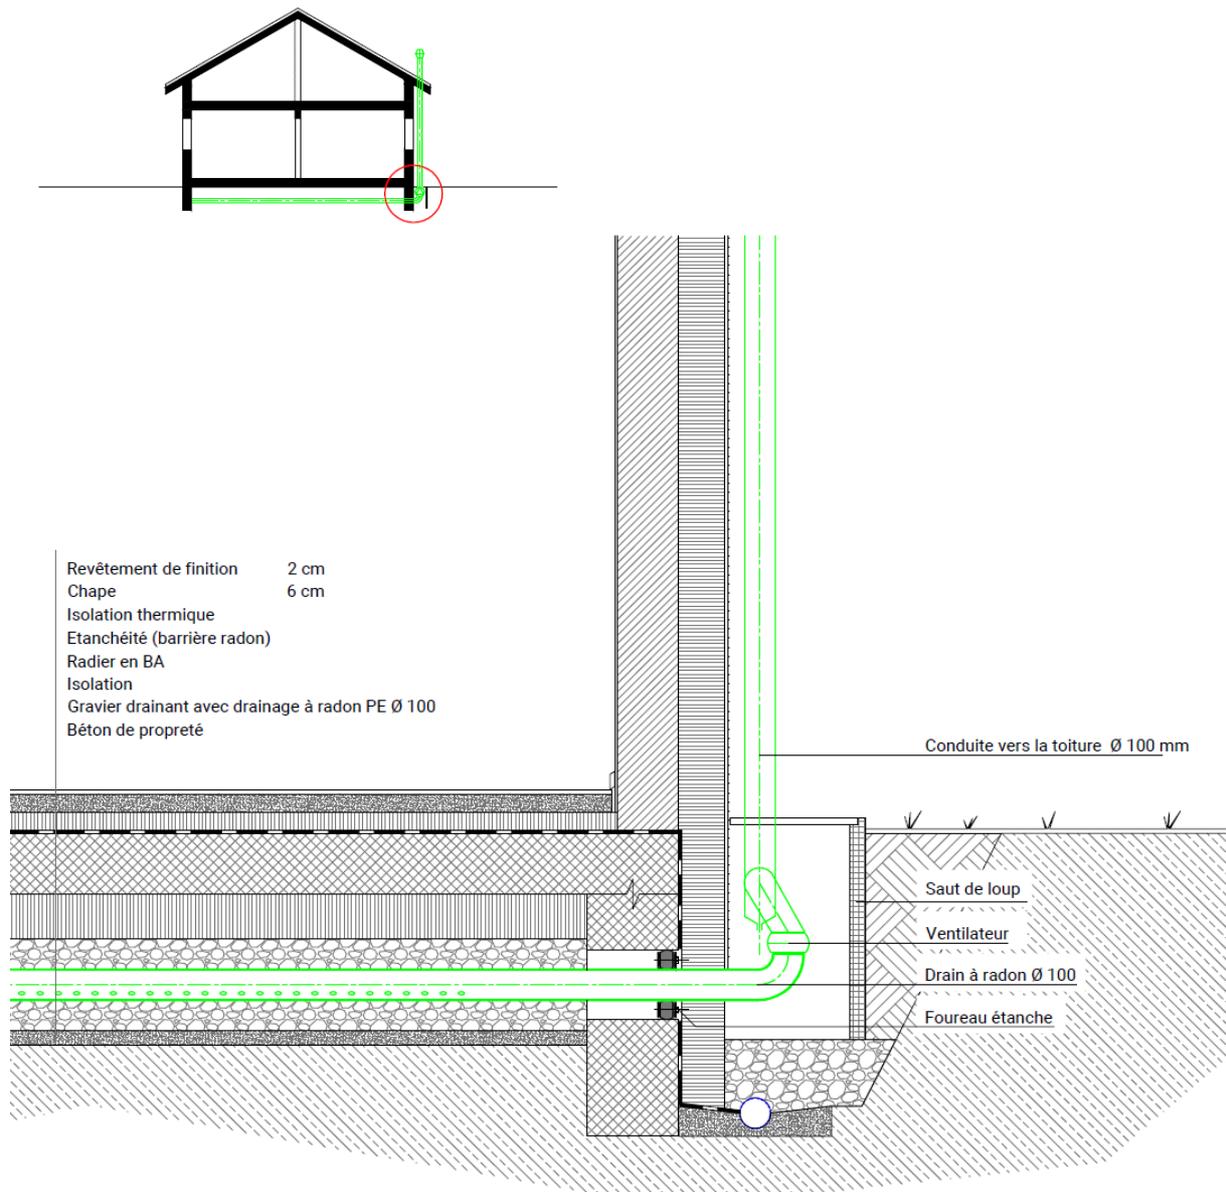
Détail en coupe d'un drainage sous radier raccordé à un ventilateur (détail : croqAIR, HEIA-FR)
